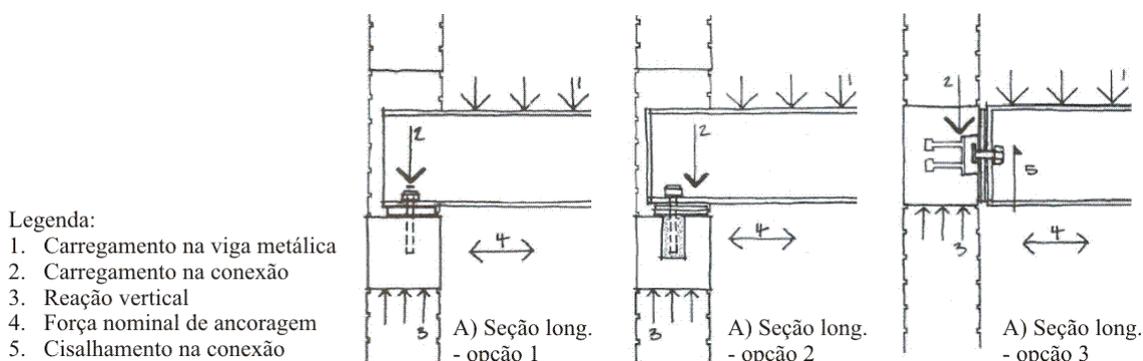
Carregamento em viga de aço apoiada em parede de alvenaria (opção 1, 2 e 3).
